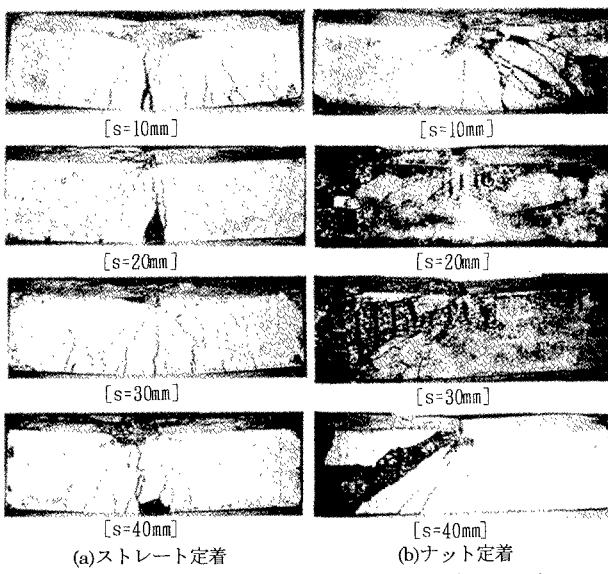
主筋定着の差によるひび割れ・破壊モード
